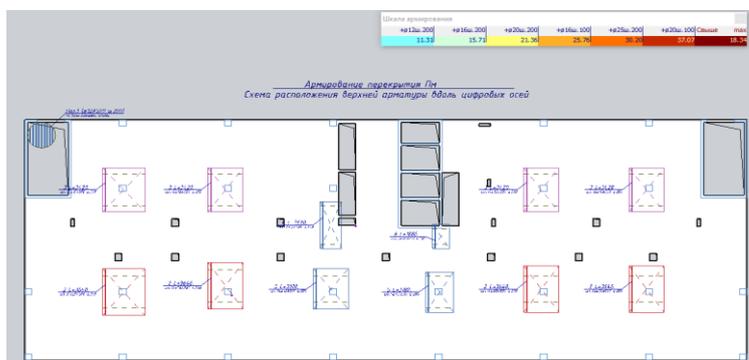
Вариант армирования верхней арматуры по оси Y
